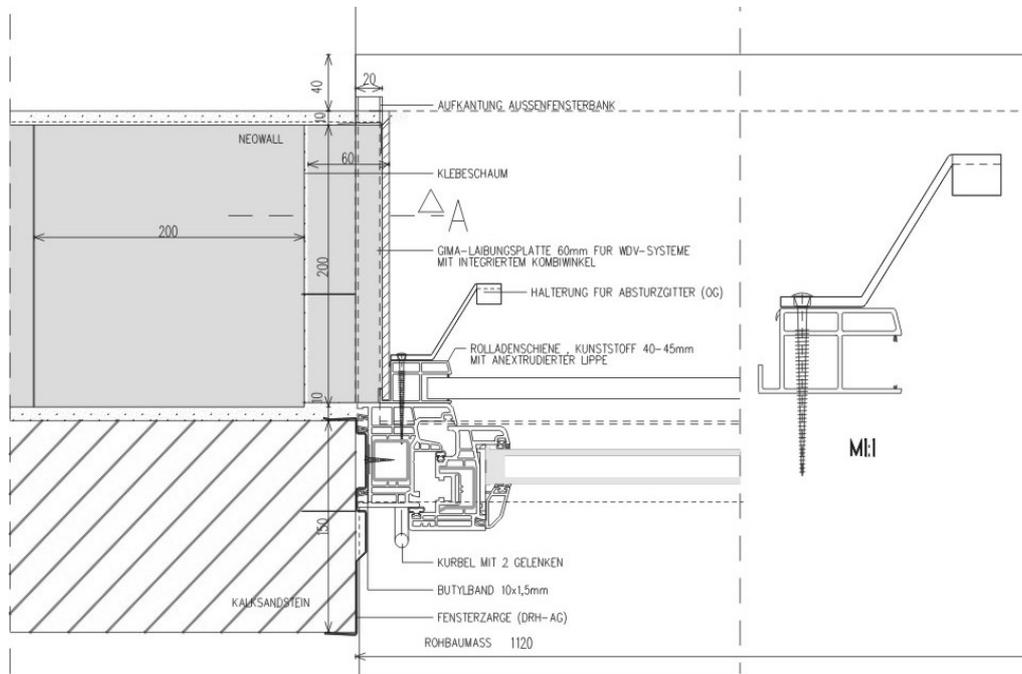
Horizontaler Fensteranschluss mit Rollladen.
